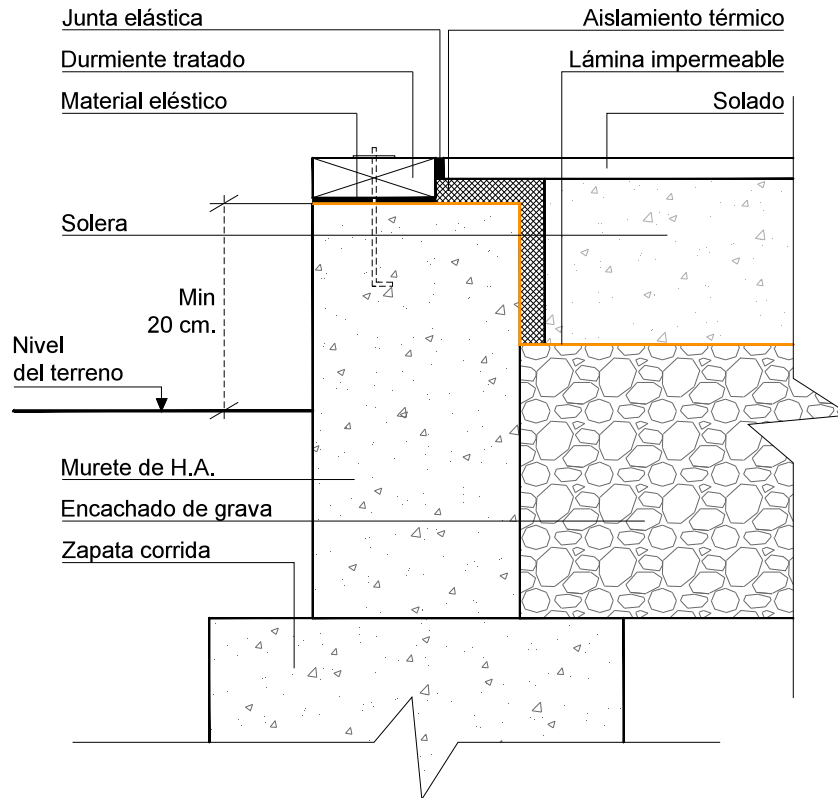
Sección constructiva de primer forjado en contacto en el terreno en el sistema de plataforma.
